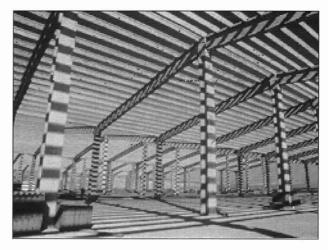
Estructura prefabricada tipo péndulo invertido.
